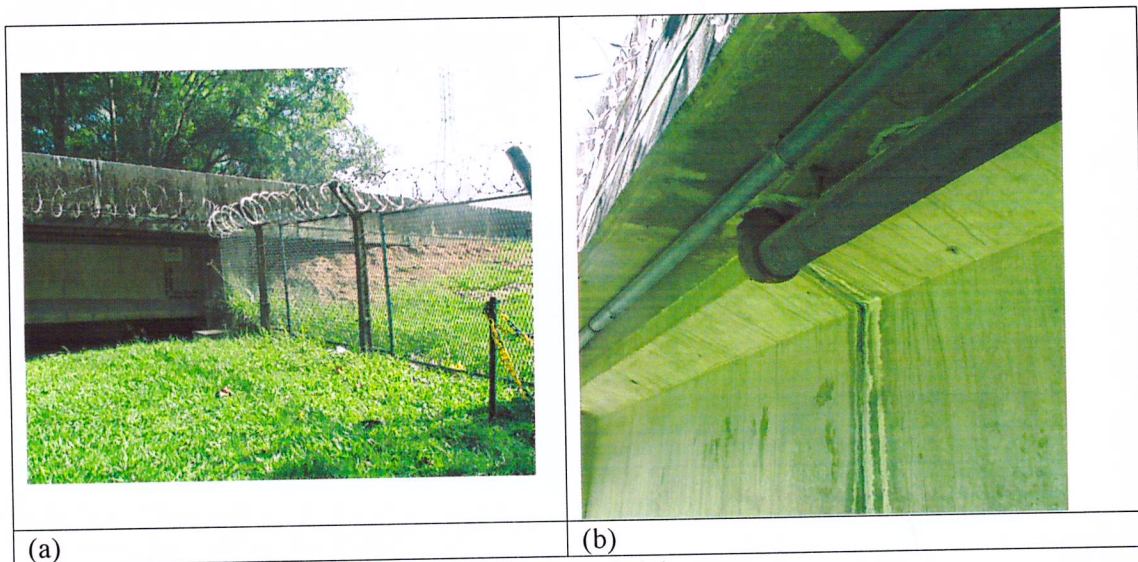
(a) encontro no eixo 15. (b) eflorescência da laje;
